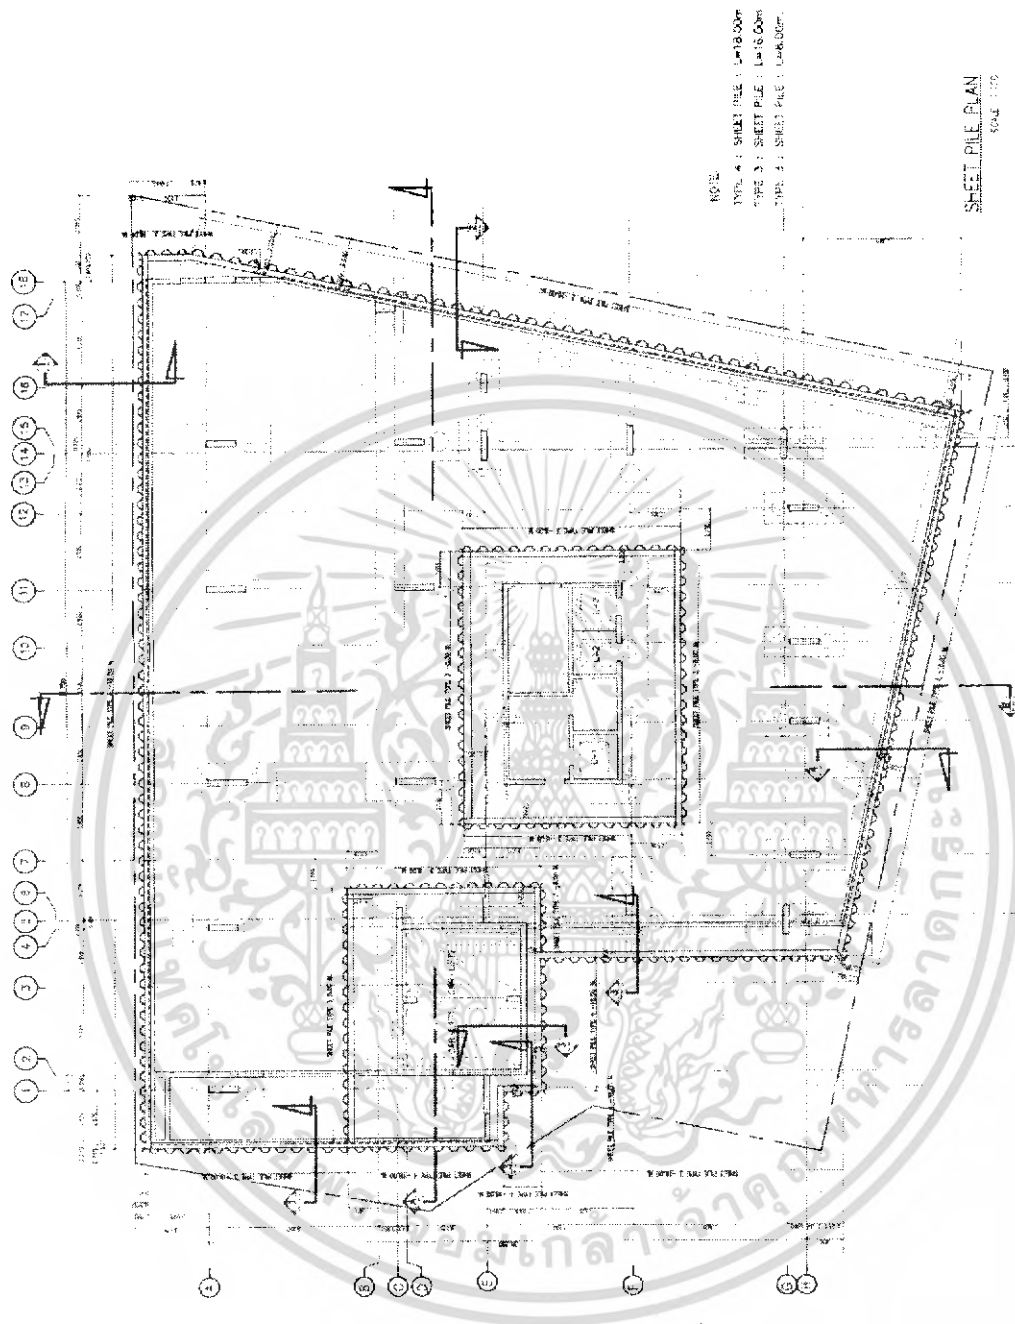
แสดง Lay out ของโครงการ Oak Wood Boutique Apartment
